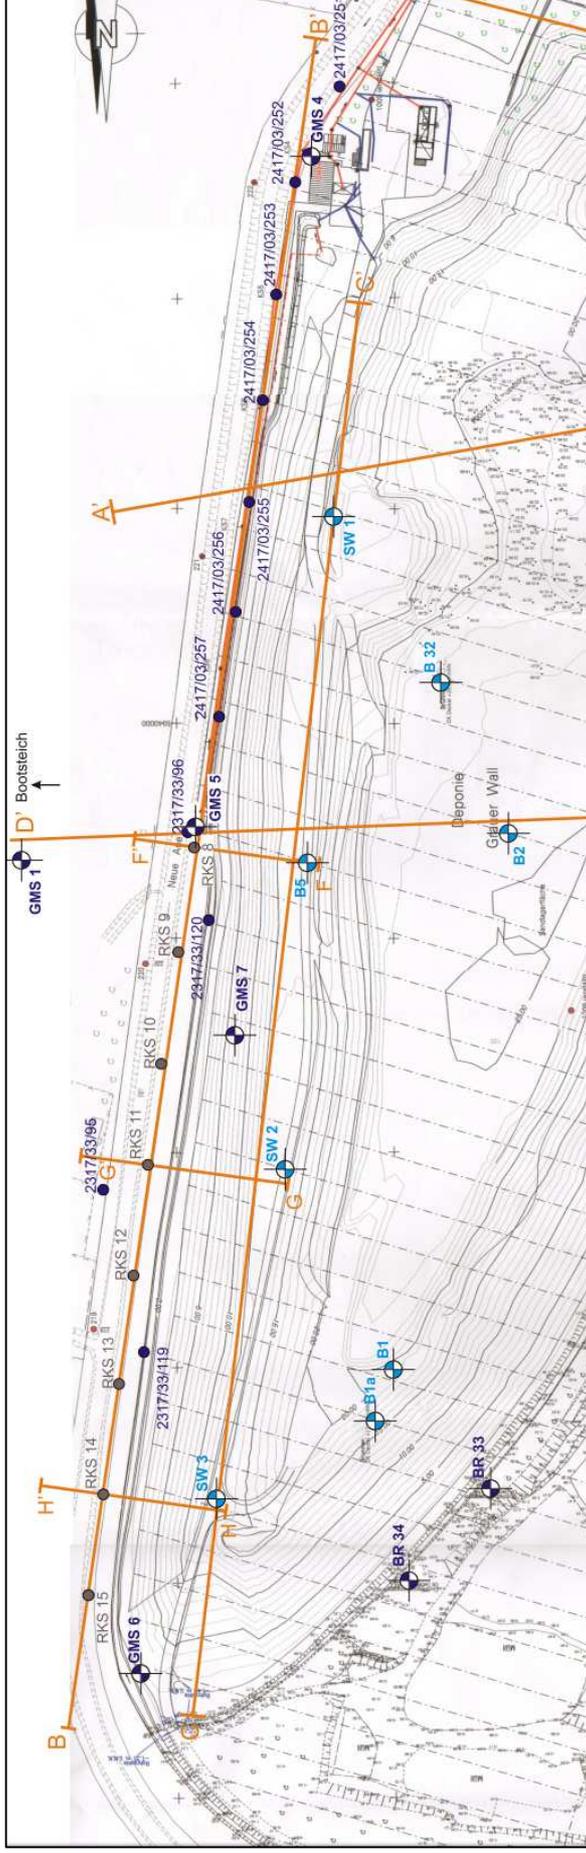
Ausschnitt Lageplan Untergrundaufschlüsse (aus [U5])
